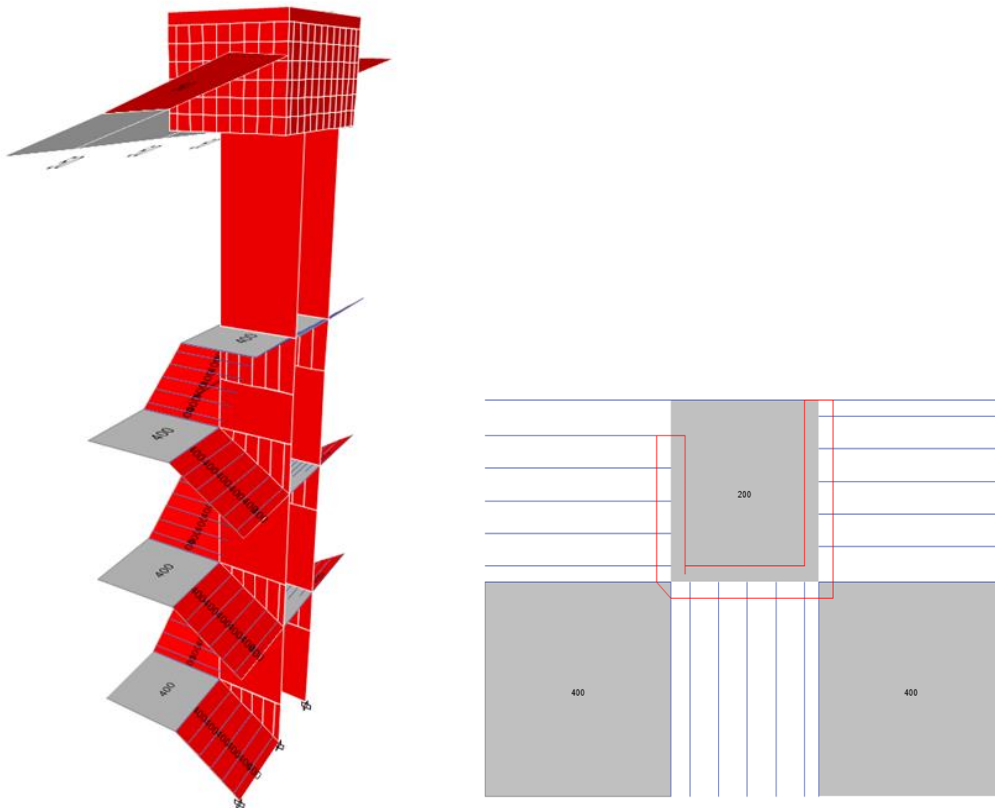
Planta Losa de Techo de la Escalera con Ascensor
